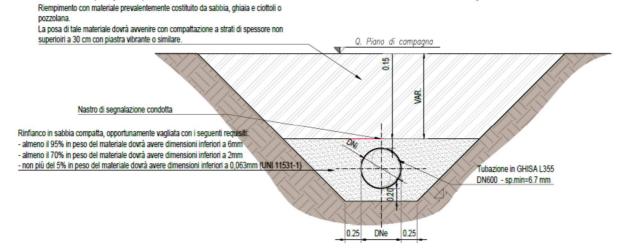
Condotta Secondaria DN600 - Sezioni Tipo
